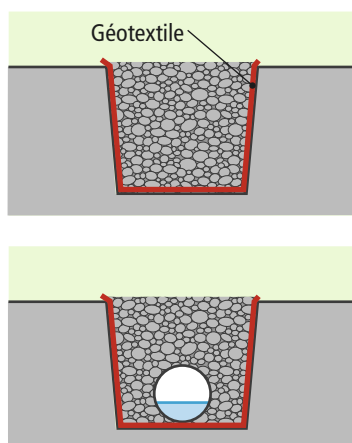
Conduite de drainage, en bas avec tuyau de drainage
